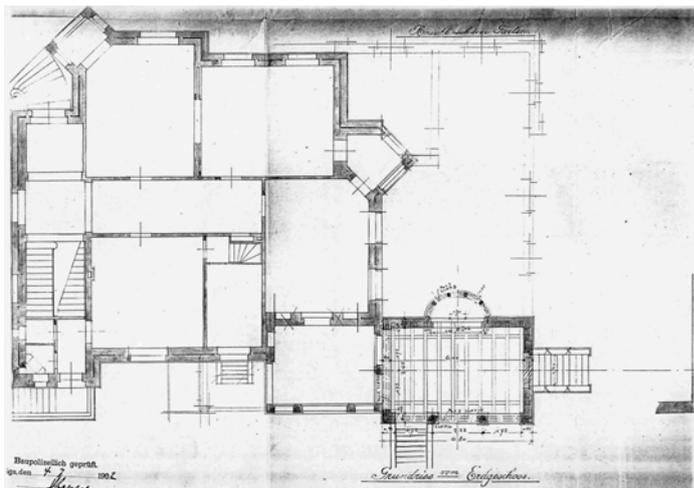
H. Plange, Grundriss Anbau, 1902
